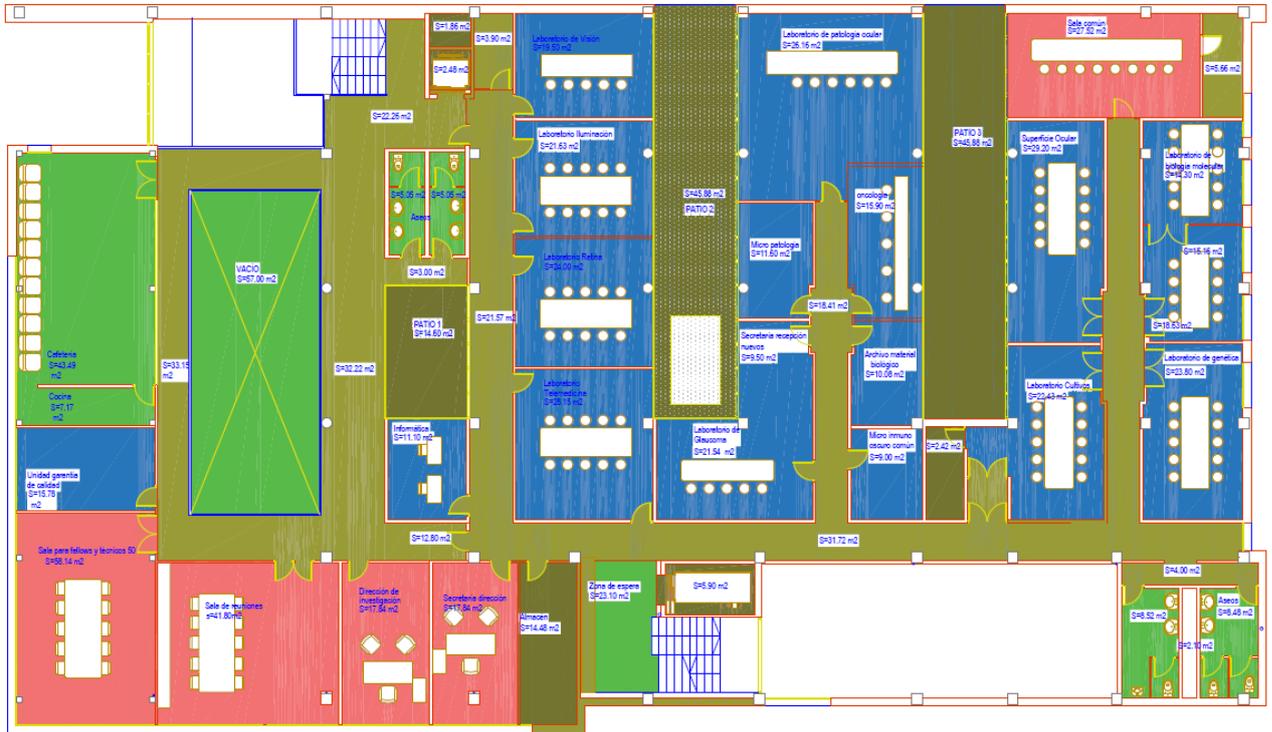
Vista de planta del nivel planta primera subdividida por zonas.
